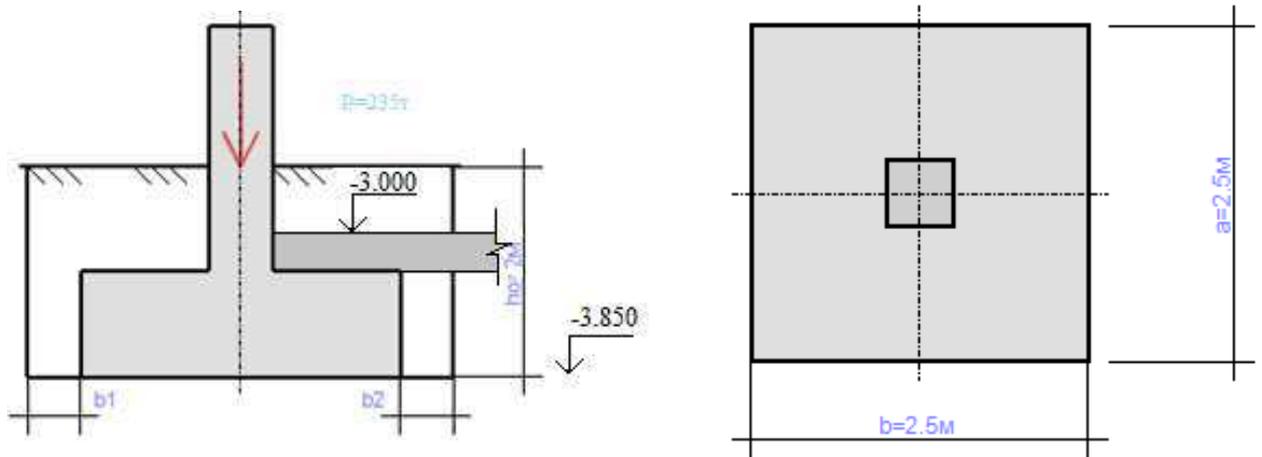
Конструктивное решение фундамента Фк – 1
